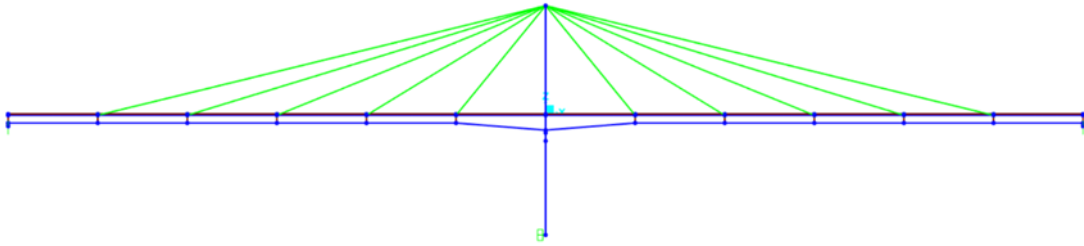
Vista en elevación del puente Extradosado. Fuente: Elaboración Propia.
